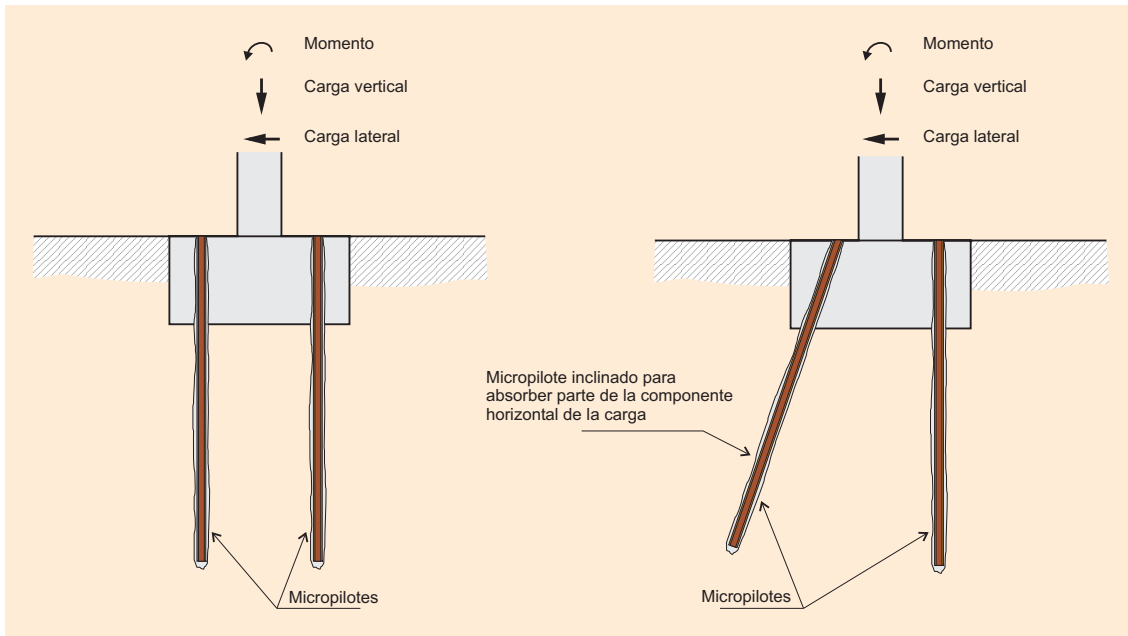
MICROPILOTES EN ESTRUCTURAS DE CIMENTACIÓN. ACCIONES A CONSIDERAR EN LOS CASOS MÁS HABITUALES
